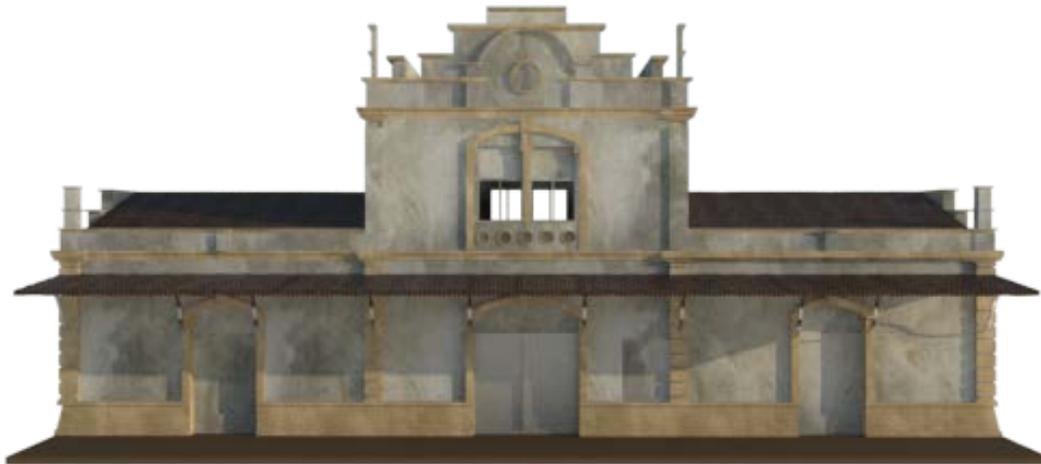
Vista posterior, Levantamiento 3D, Estación del ferrocarril Sur
